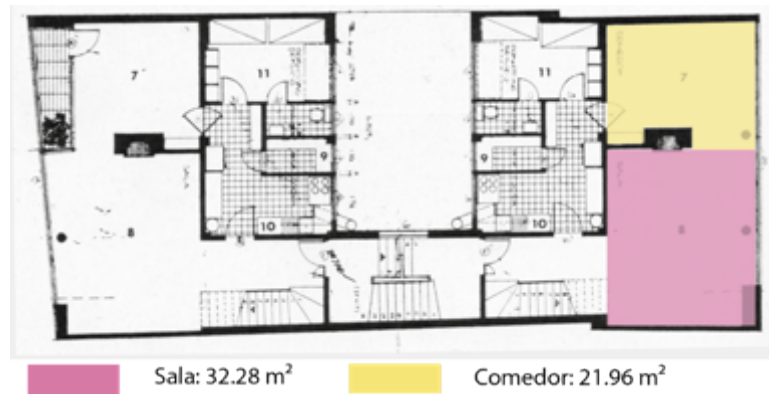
Planta de segundo piso (primer nivel dúplex) - Cuellar, Serrano, Gómez – 1949
